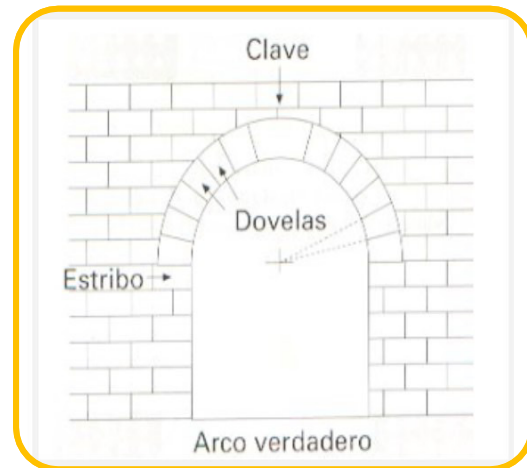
Recuperado de Elementos estructurales de la arquitectura: el arco.
